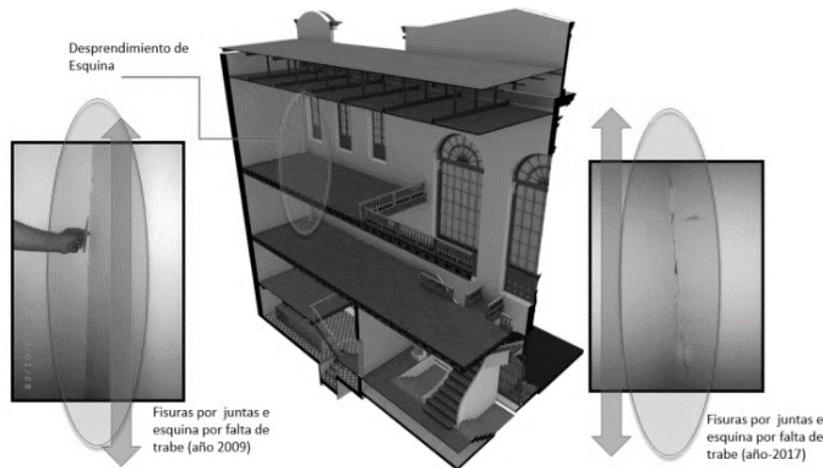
Desprendimiento de esquina – fisuras verticales de junta de 1 a 3 mm,
